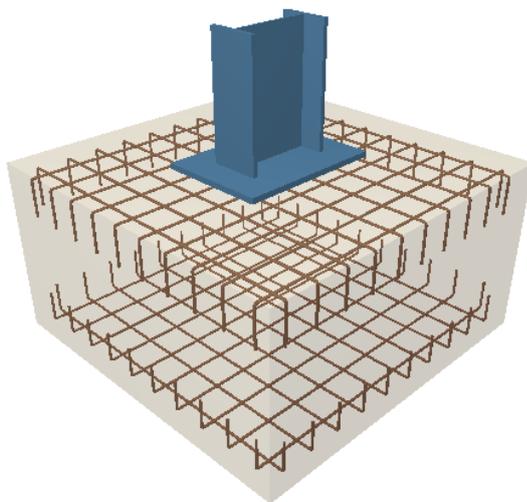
Zapata Z7. Fuente: CYPE 2017
